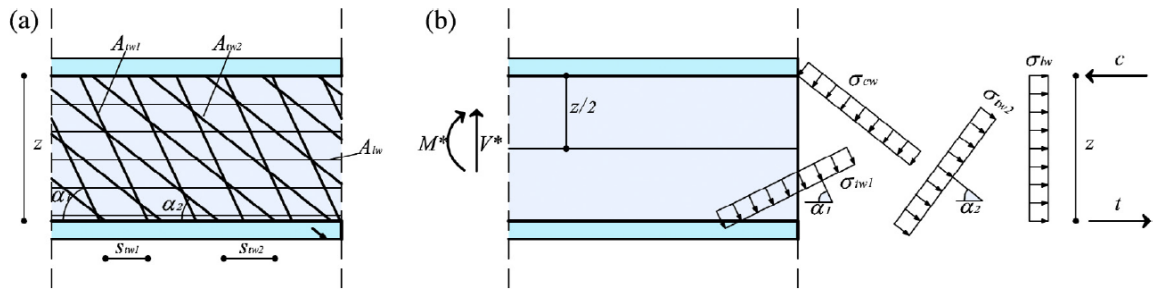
(a) Tipos de refuerzo (b) Campos de tensión (fuente: Colajanni, 2014.)
